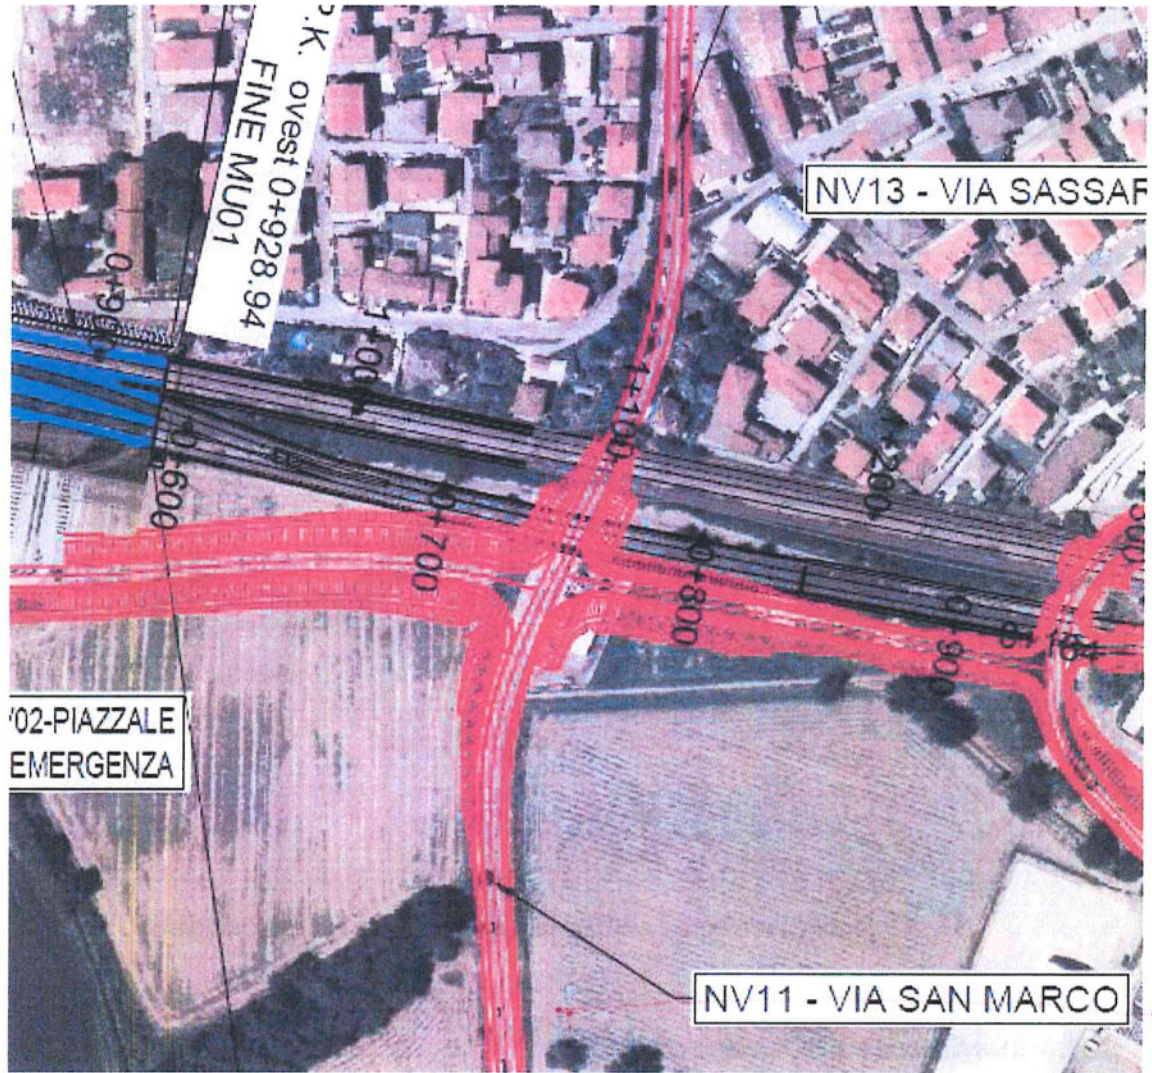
NV11 – Stralcio planimetrico su ortofoto Via San Marco.
